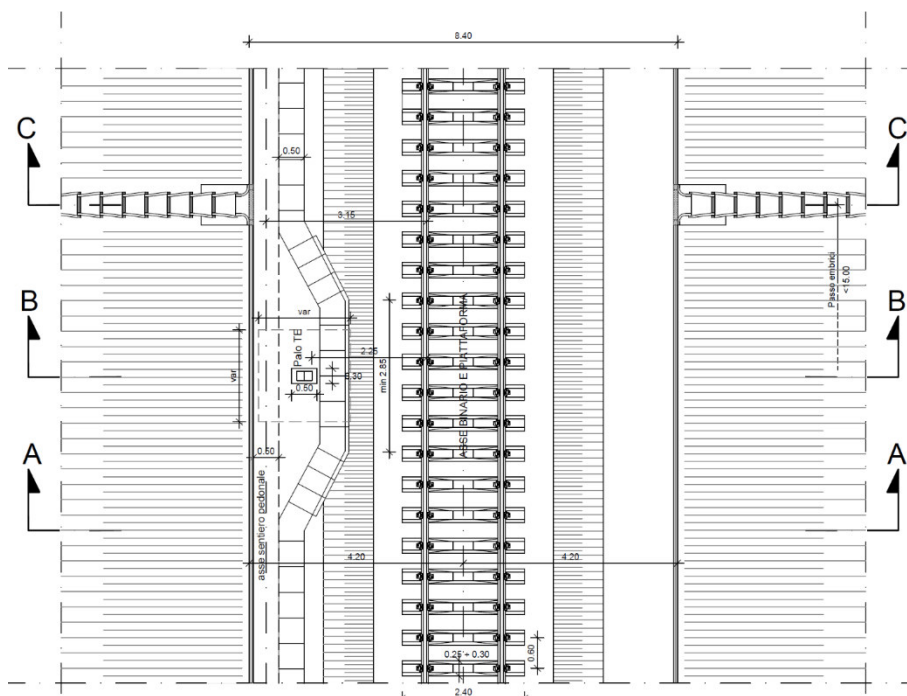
Stralcio planimetrico con sezione tipo ferroviaria in rilevato a singolo binario in rettilifo
